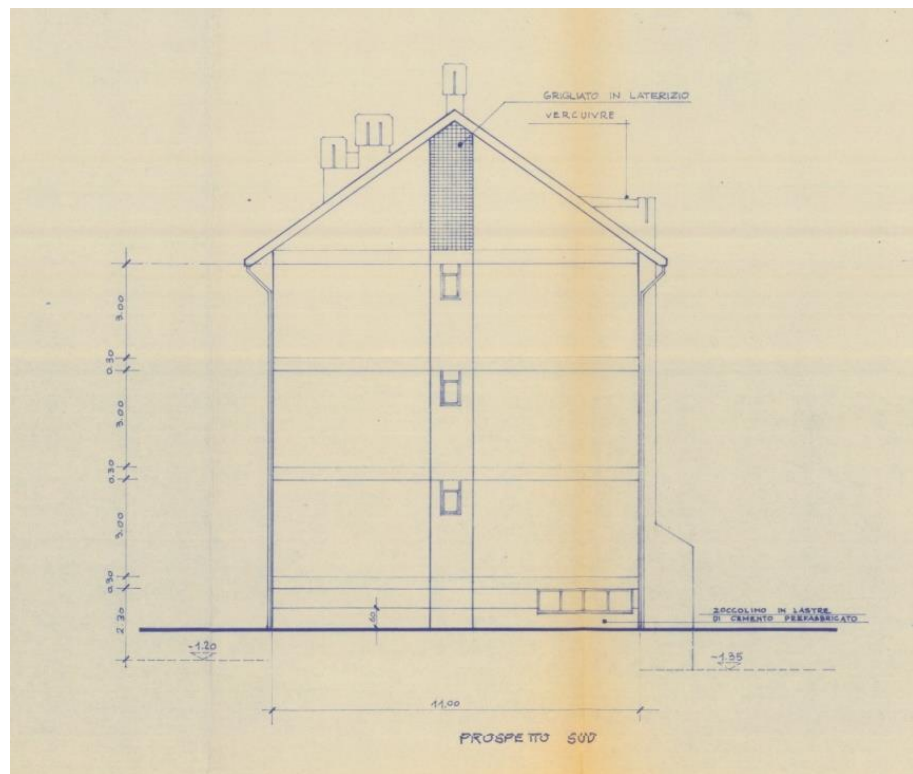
, Prospetto Sud-Est, scansione progetto originale
